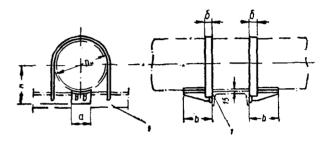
Опоры неподвижные хомутовые, тип II, для,  $D_{\rm H}\!=\!273\div1020$  мм I- несущая конструкция
